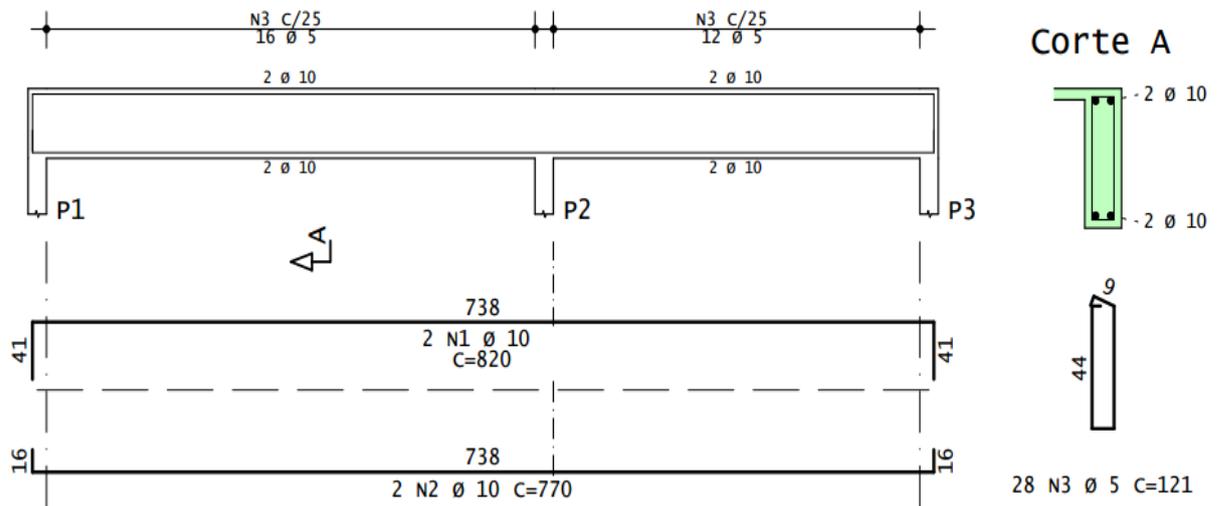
Armadura da viga V2 – coberta (nível +6,00)
